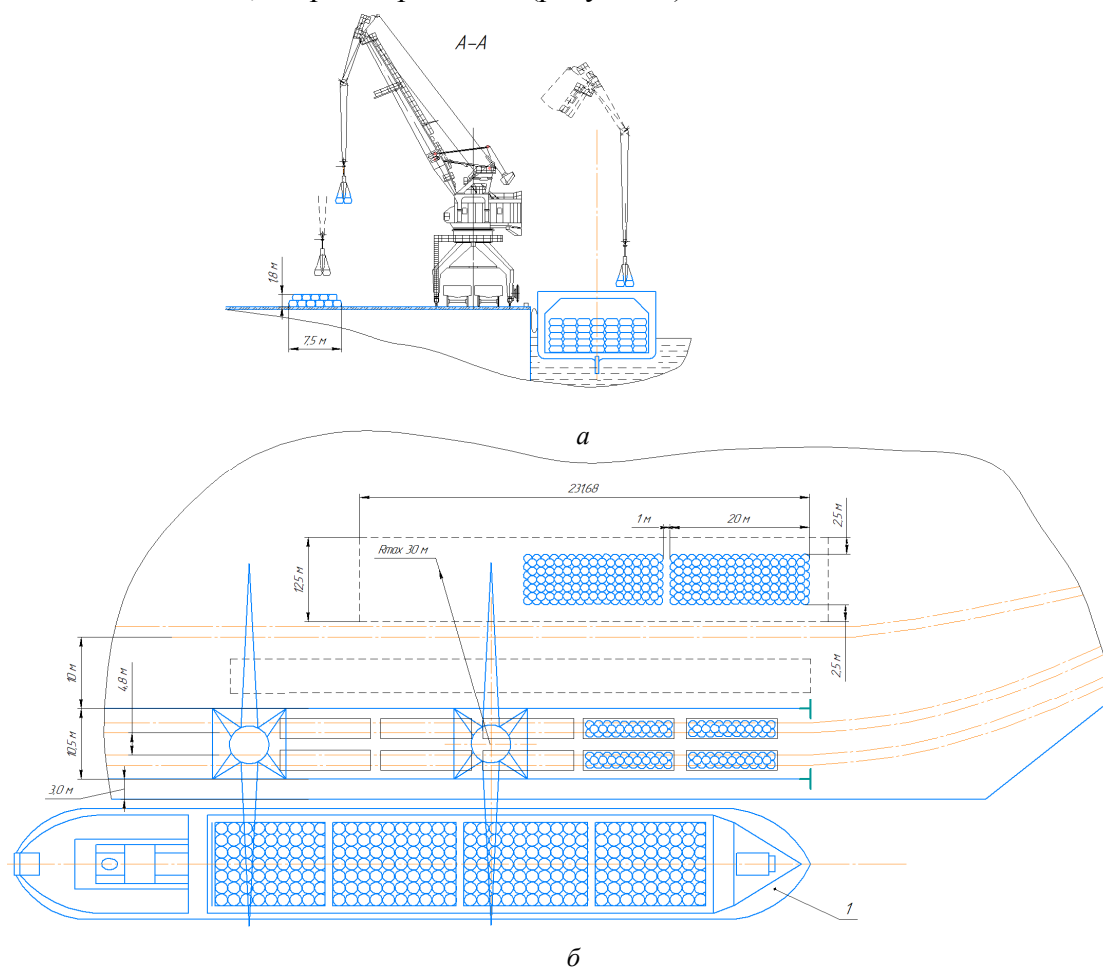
Схема перегрузки магистральных труб нефтепровода
